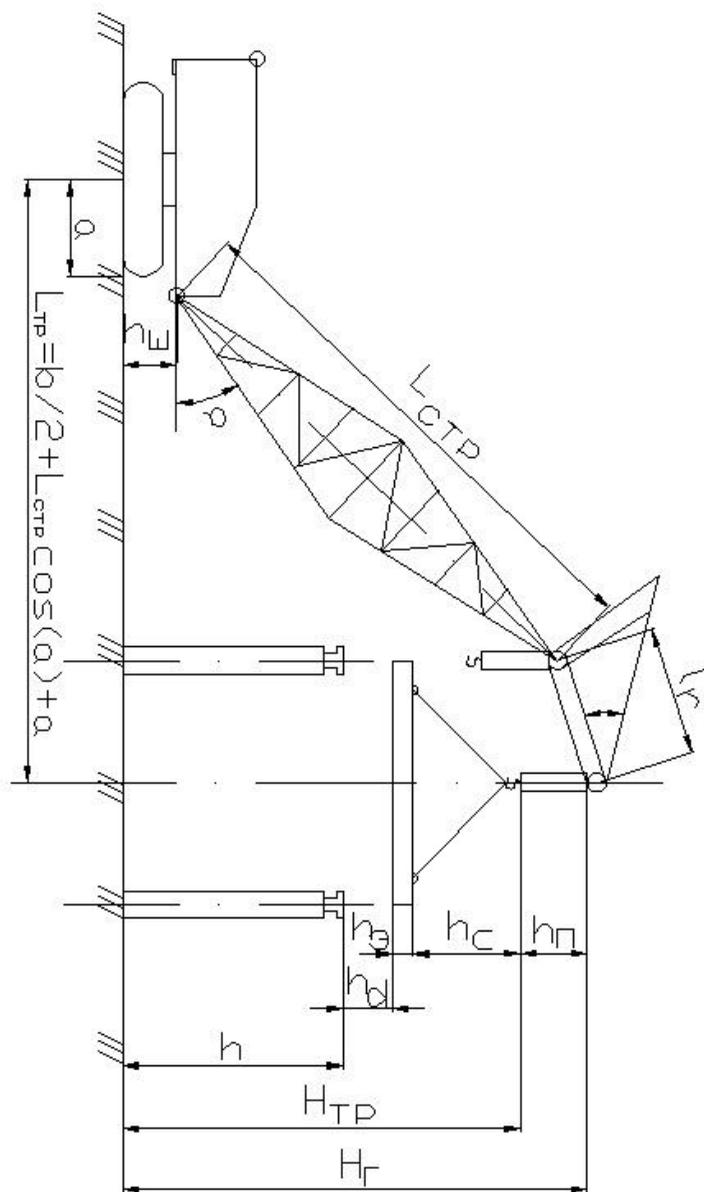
, 4 – Схема монтажа конструкций стреловым краном с гуськом
